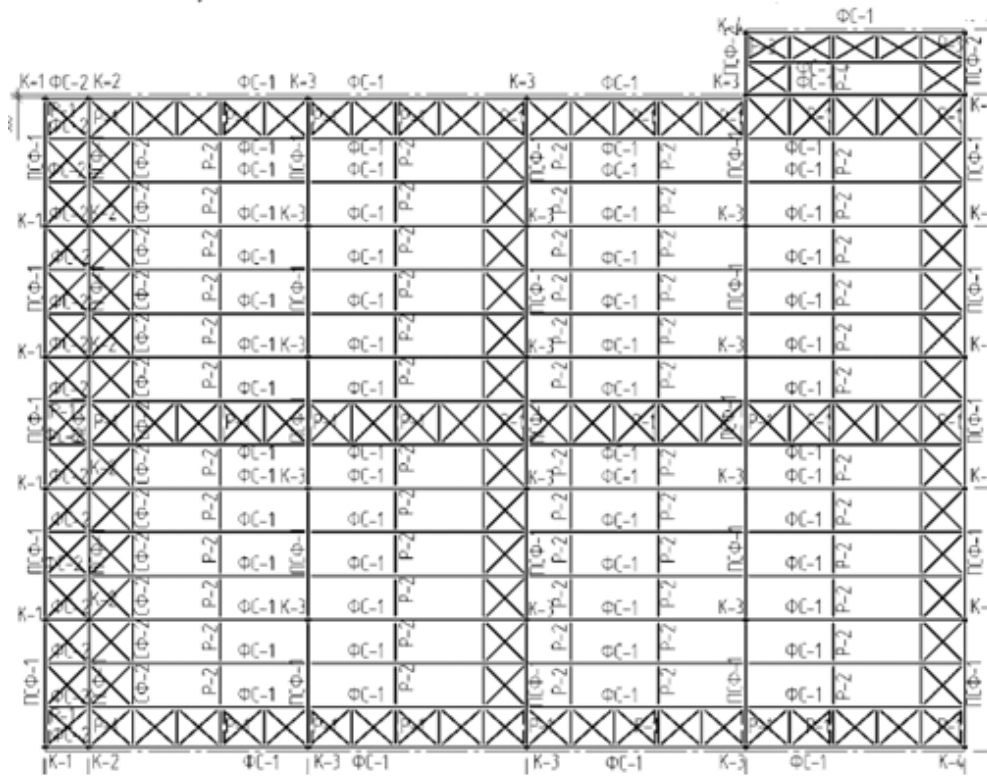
Схема расположения несущих конструкций покрытия, связей по нижним поясам ферм
